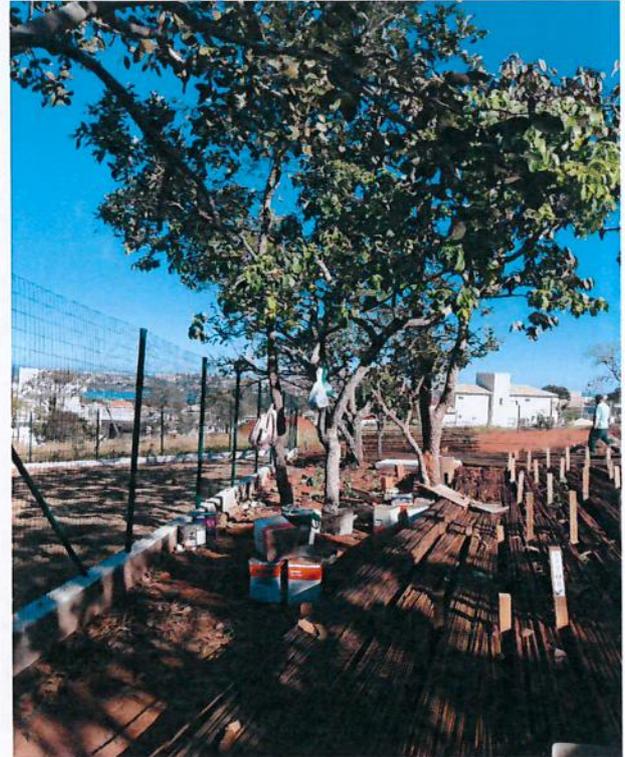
e 04: Pequizeiro e pimenta de macaco situados na área de passeio.
